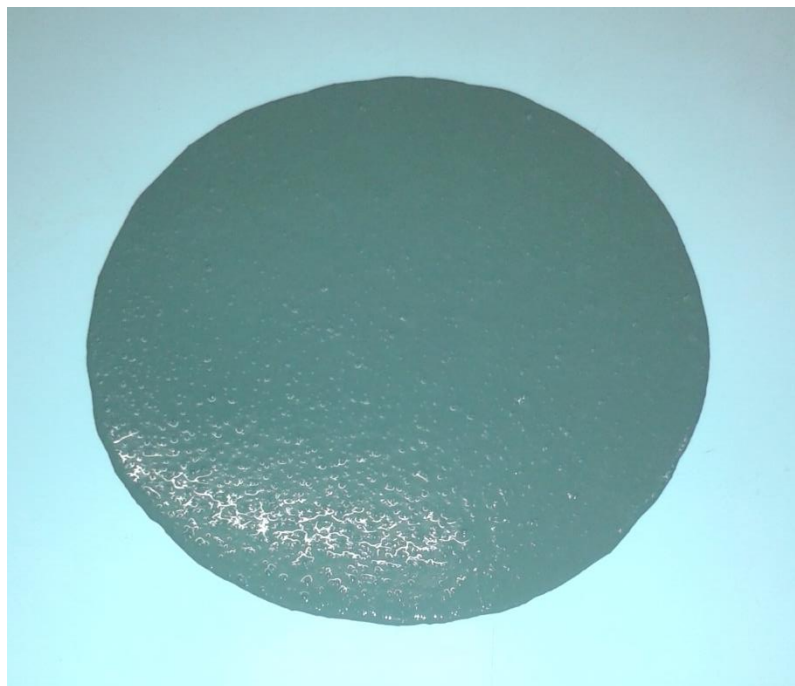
Aspeto da argamassa n final do ensaio de espalhamento.
